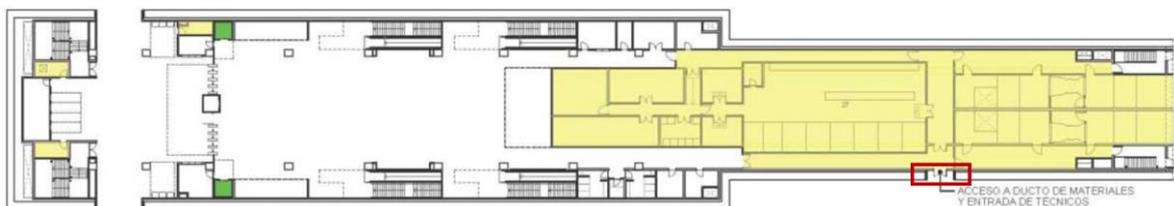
Planta Vestíbulo con acceso a zona técnica. Fase de Estudio Técnico
